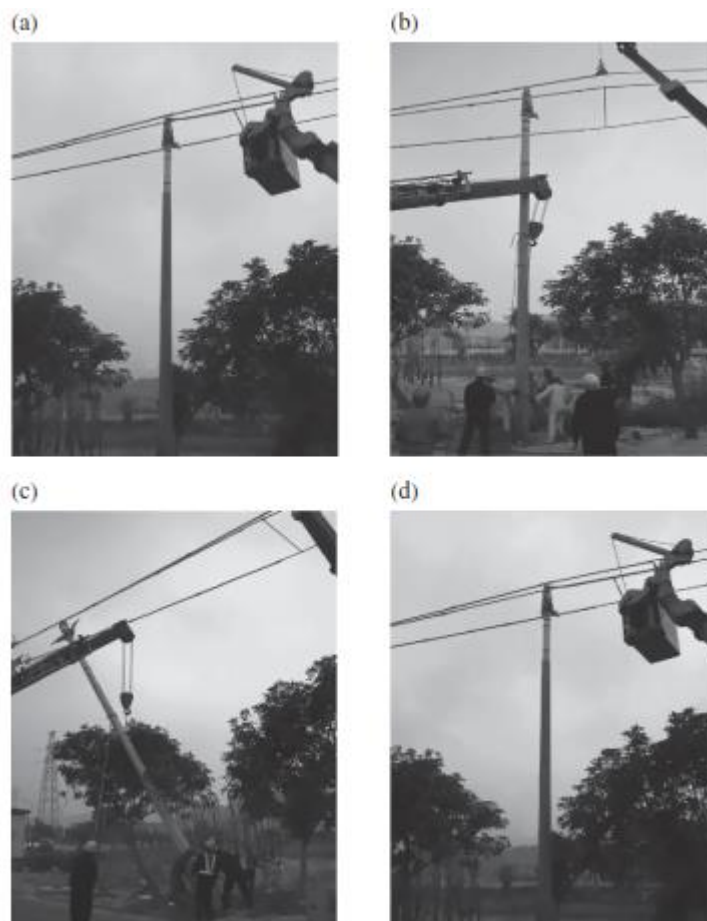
Замена подвесной опоры. а) установка изолирующих покрытий и опорных штанг; б) ослабление перевязочной проволоки и поднимаемых проводов; с) подъем и извлечение старой опоры и установка новой; д) закрепление проводов.
